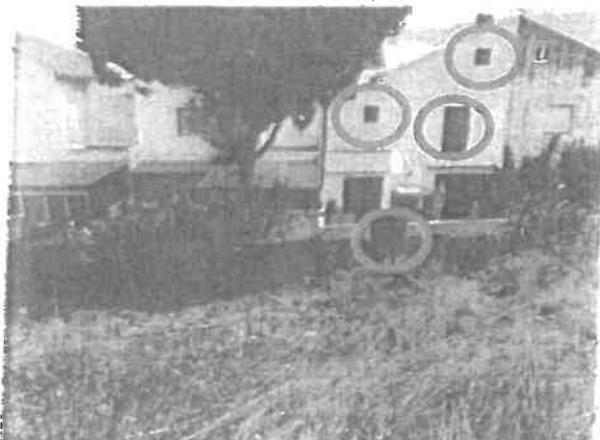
Vão de porta para lote privado, vão de janela ao nível do sótão e aumento da área de construção.
